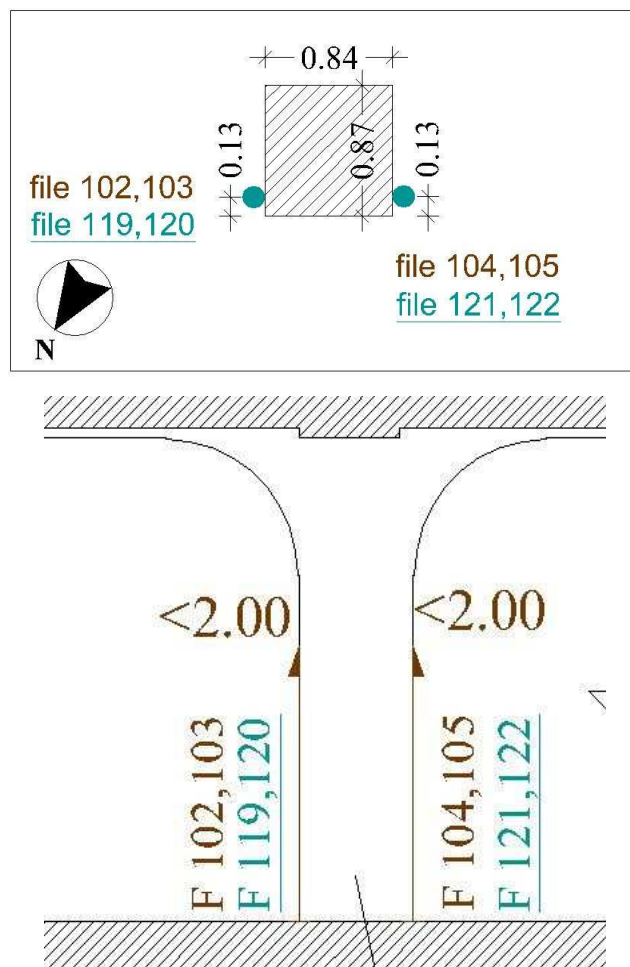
Posizioni di prova sul Pilastro2: in alto è rappresentata la sezione del pilastro, in basso il prospetto rivolto verso Sud.
